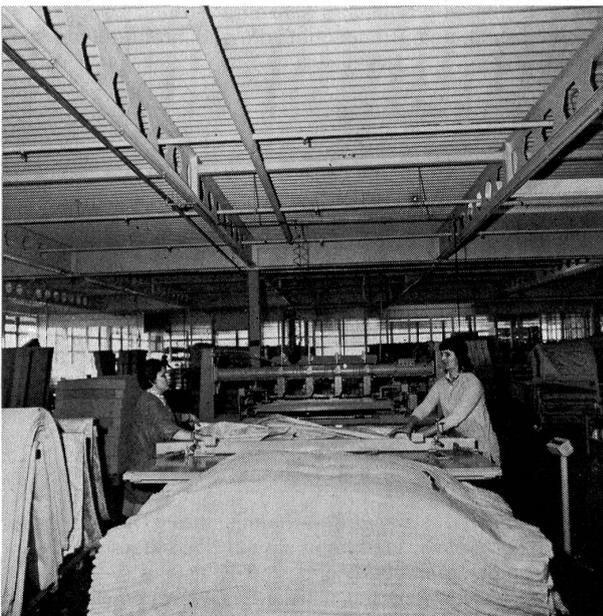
Sprinklernetz in der Fabrikation eines Textilunternehmens. Netz offen montiert für Schutzklasse SH Kat. II. Installiert sind 1009 Sprinkler. (Sulzer Pressefoto)
